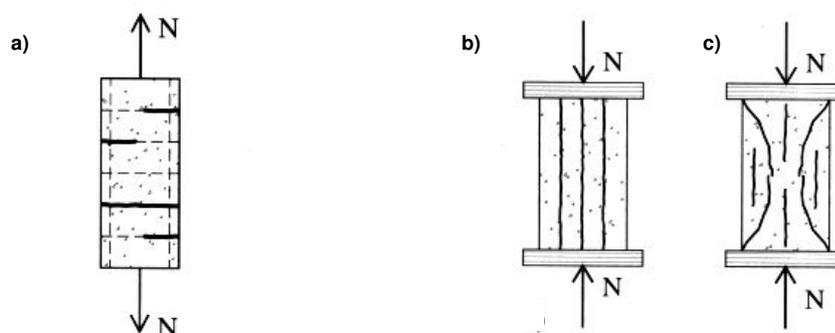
Representação esquemática da fissuração devido ao esforço de tração e compressão (CÁNOVAS, 1988).
